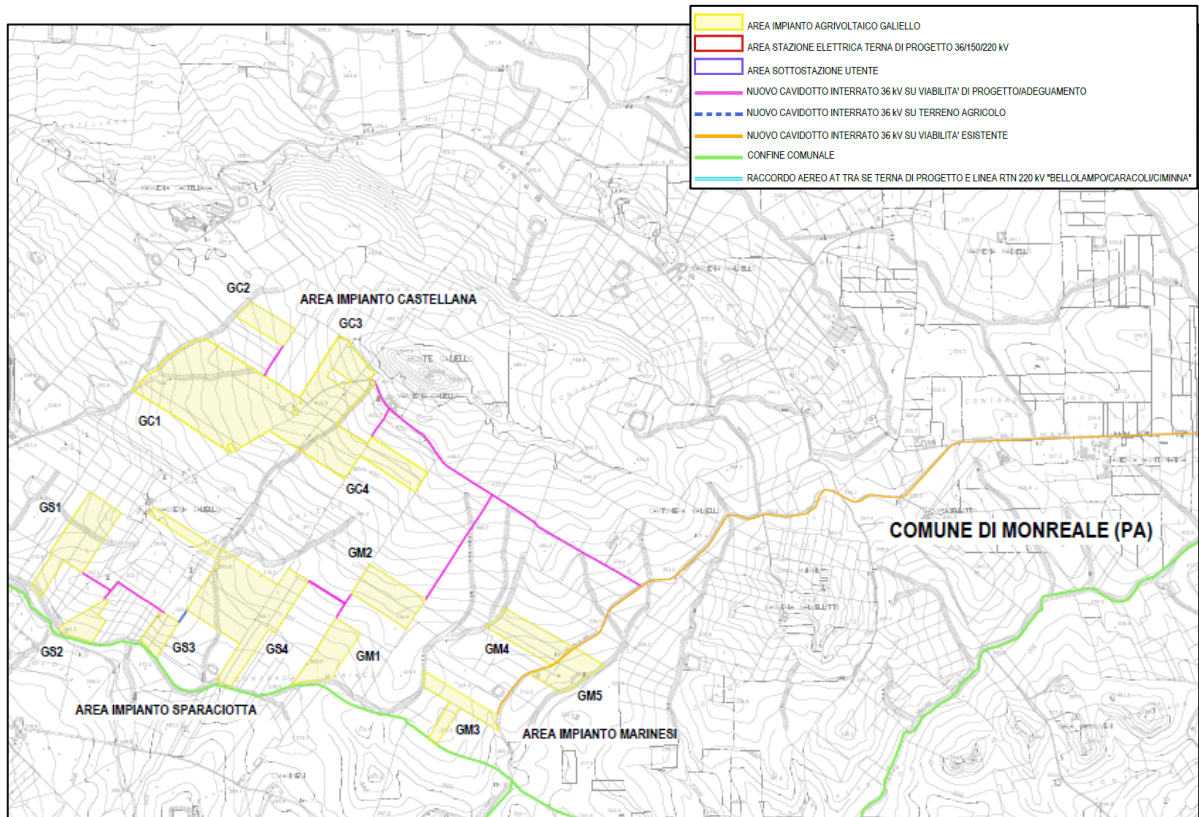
Inquadramento opere in progetto (impianto) su CTR (Scala 1:10.000)
